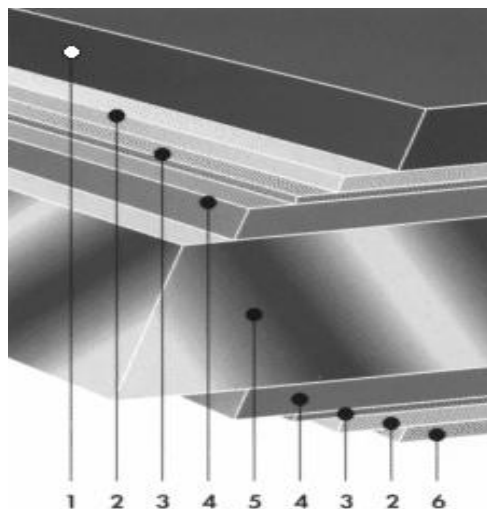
Схема шарів поперечного перерізу металочерепиці: 1 – покриття; 2 – ґрунтувальний шар; 3 – пасивуючий шар; 4 – оцинковка; 5 – сталь 0,4 - 0,5 мм; 6 – шар фарби зворотного боку
